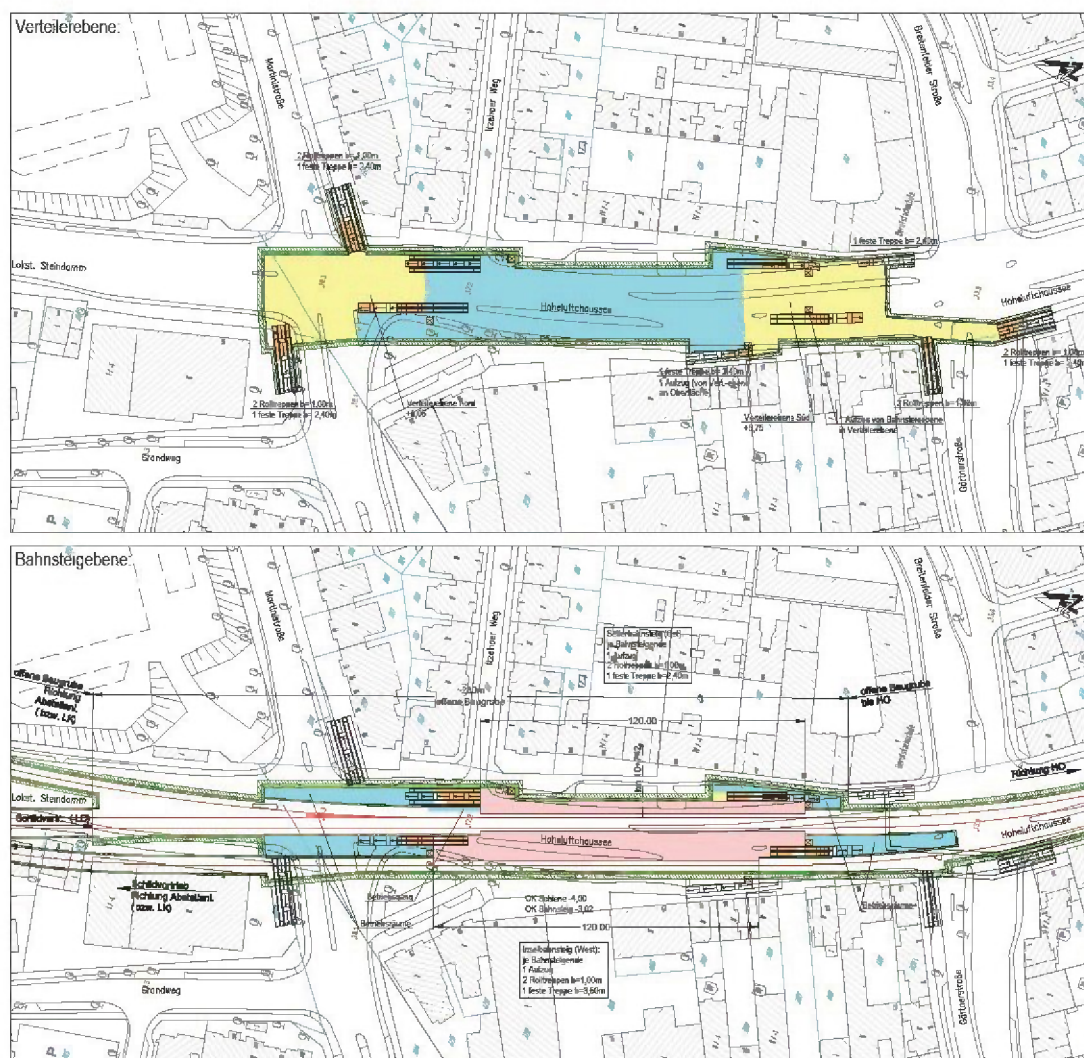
Lageplan Haltestelle Gärtnerstraße II
